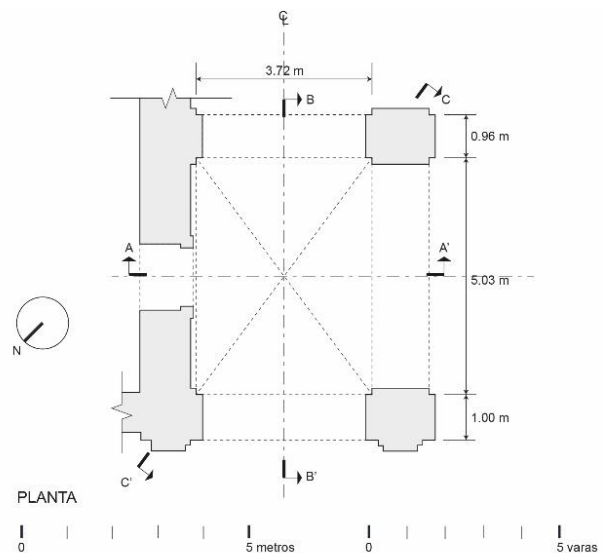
91 Planta arquitectónica de la bóveda de arista denominada B-02a.
